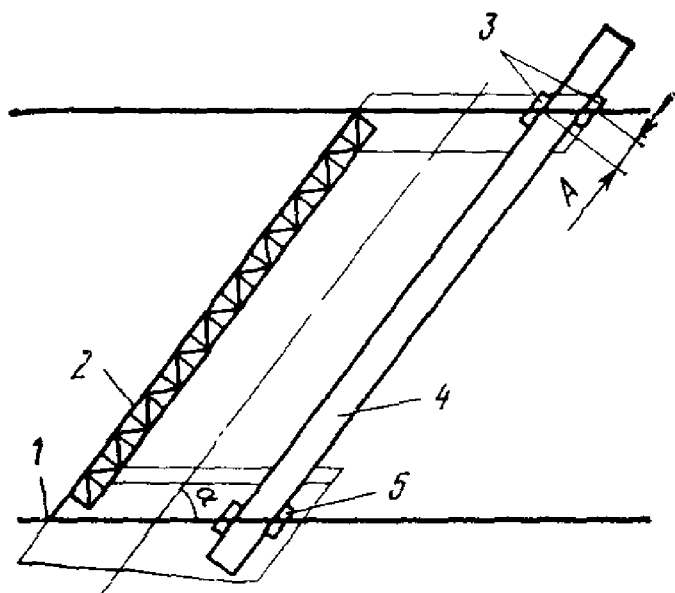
Схема установки крана МКШ-100 на монтаже пролетного строения косых мостов:
